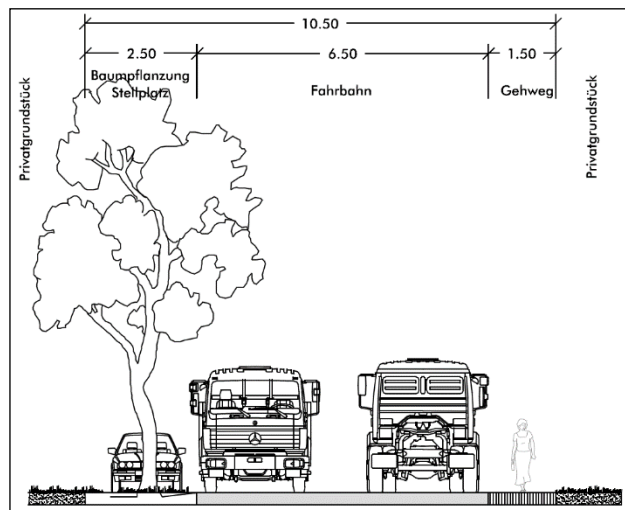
Straßenquerschnitt Planstraßen A, B, C, schematisch
